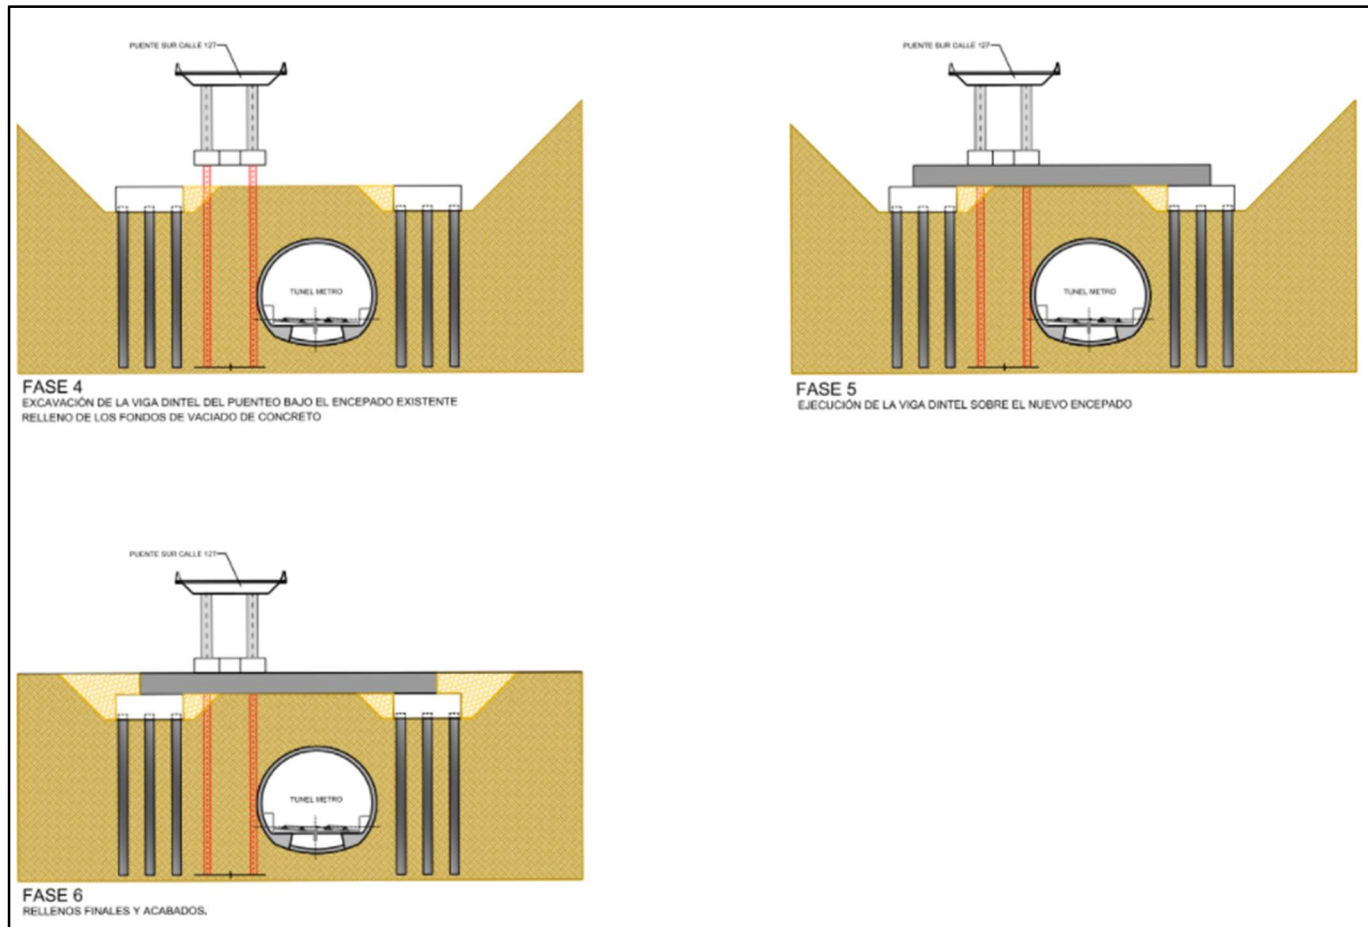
Proceso Constructivo Propuesto. Paso bajo estructura sur de la Calle 127
